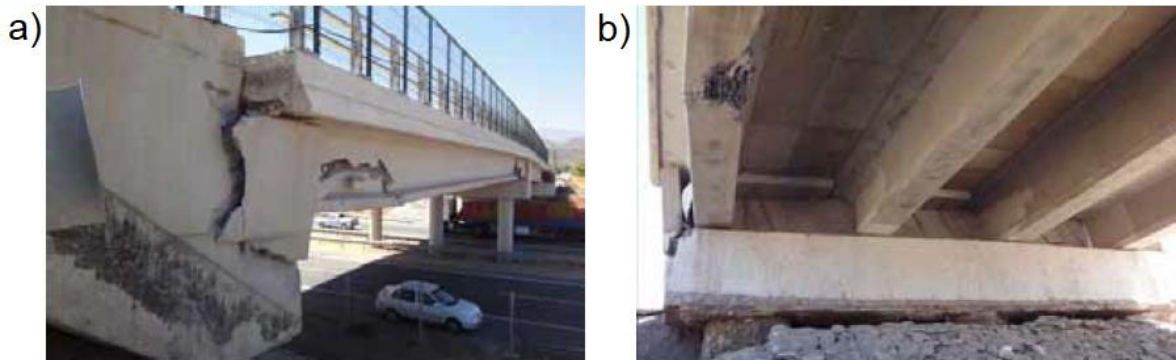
a) Daños en tope lateral de estribo, b) daños en viga pretensada [17]
